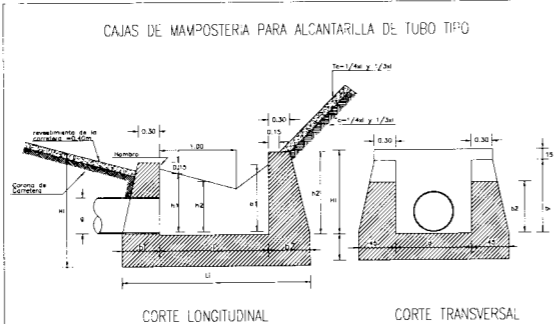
TUBO DE CONCRETO APOYADO SOBRE MURO DE MAMPOSTERÍA
